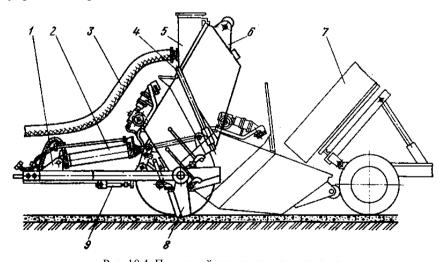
Прицепной распределитель цемента: 1 – рама; 2 – гидроцилиндр подъема бункера; 3 – рукав; 4, 9 – подставки; 5 – крышка с рукавным фильтром; 6 – упор; 7 – самосвал; 8 – сошник
